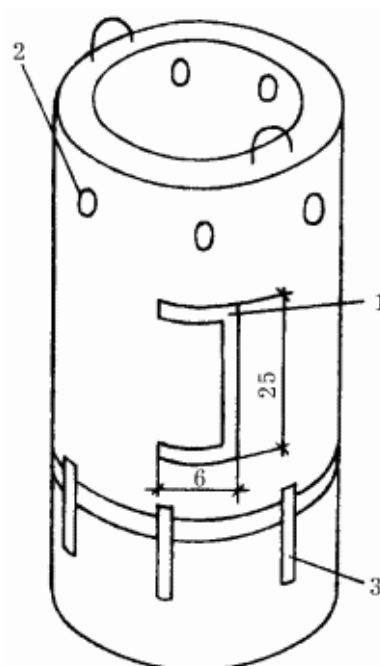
Железобетонное кольцо со вставленными арматурными стержнями: 1 – ушки; 2 – стержень; 3 – скобочка.
